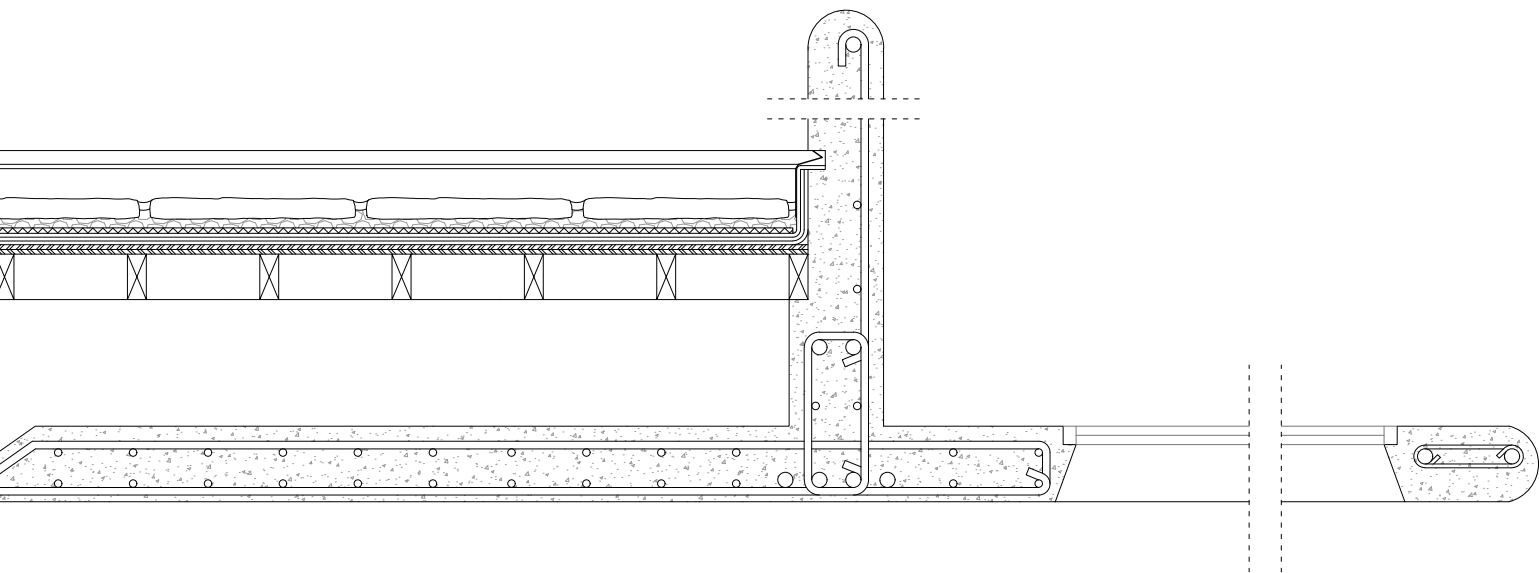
Detalle de forjado terraza primera planta, sección sur-norte
